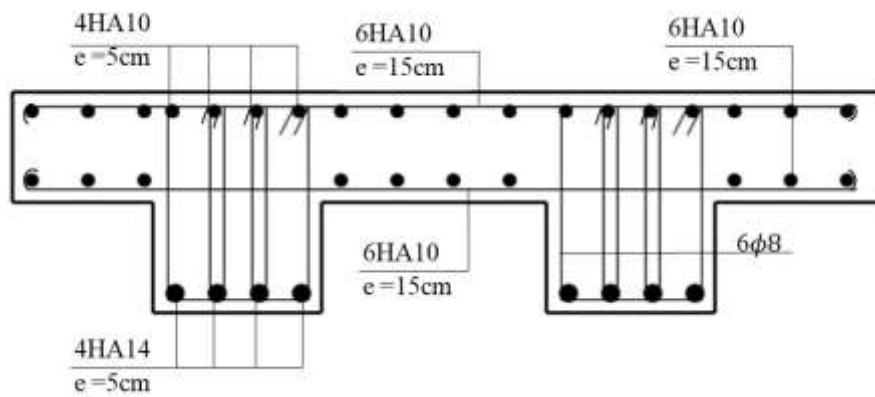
Schéma de ferrailage de palier de repos d'un escalier sur limon central.
